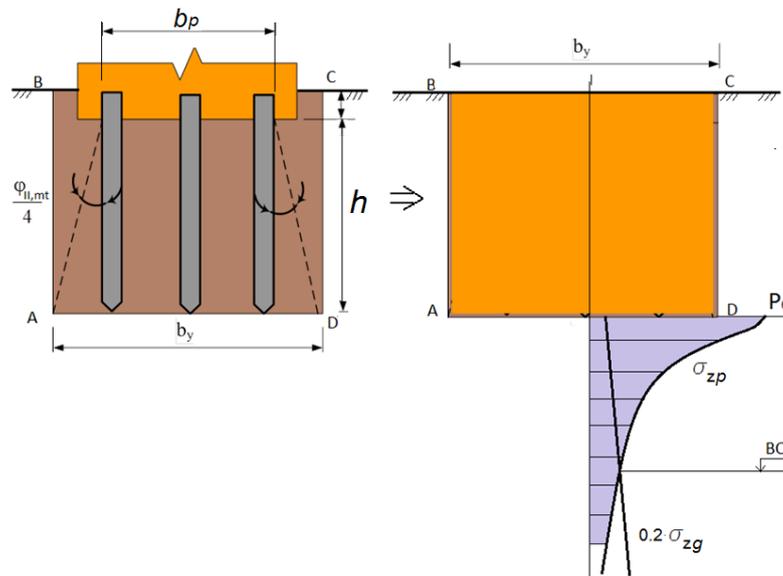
Принцип перехода от свайного фундамента к условному при определении его осадки.
